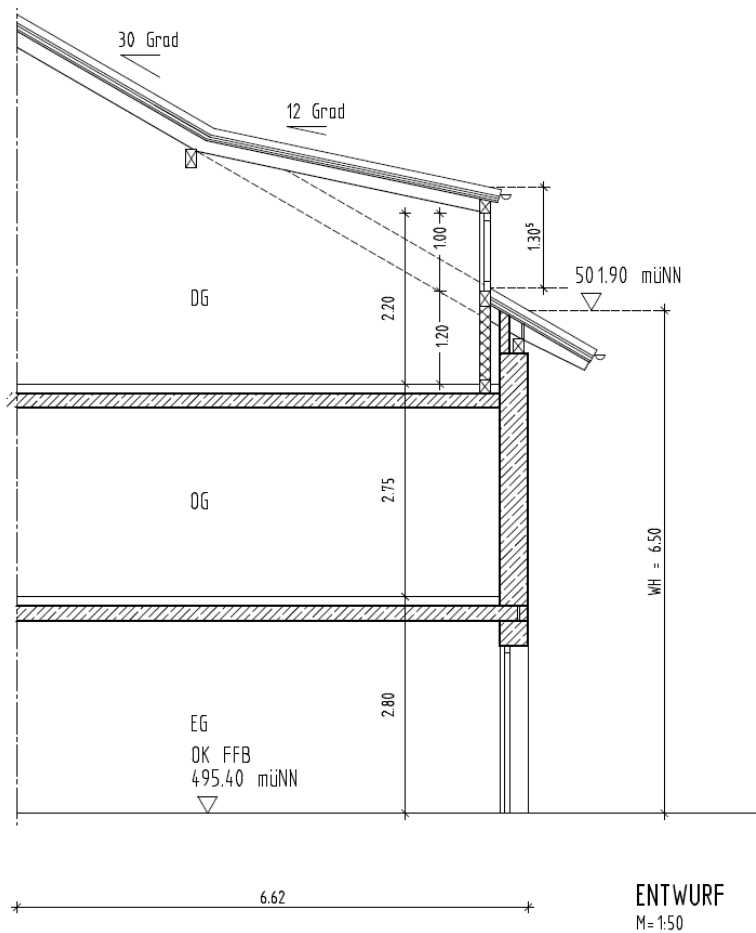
Schnitt durch das Wohngebäude, Quelle: Bauamt Gemeinde Oberaudorf, Stand 05.2025
